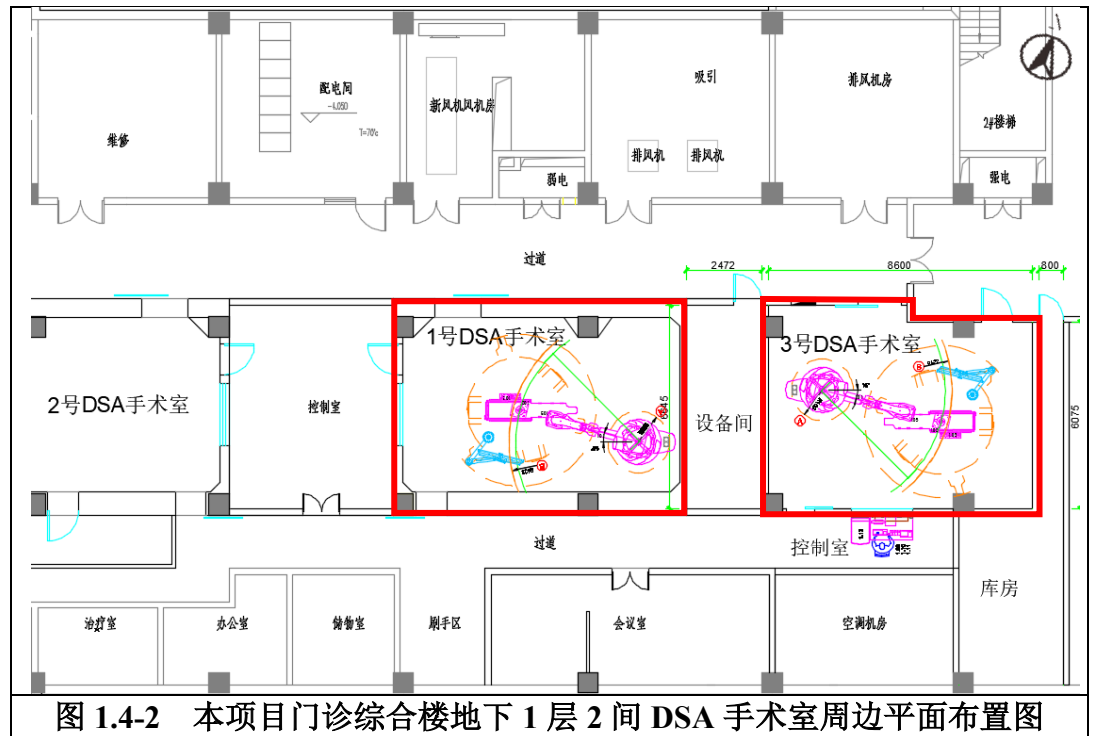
本项目门诊综合楼地下 1 层 2 间 DSA 手术室周边平面布置图
